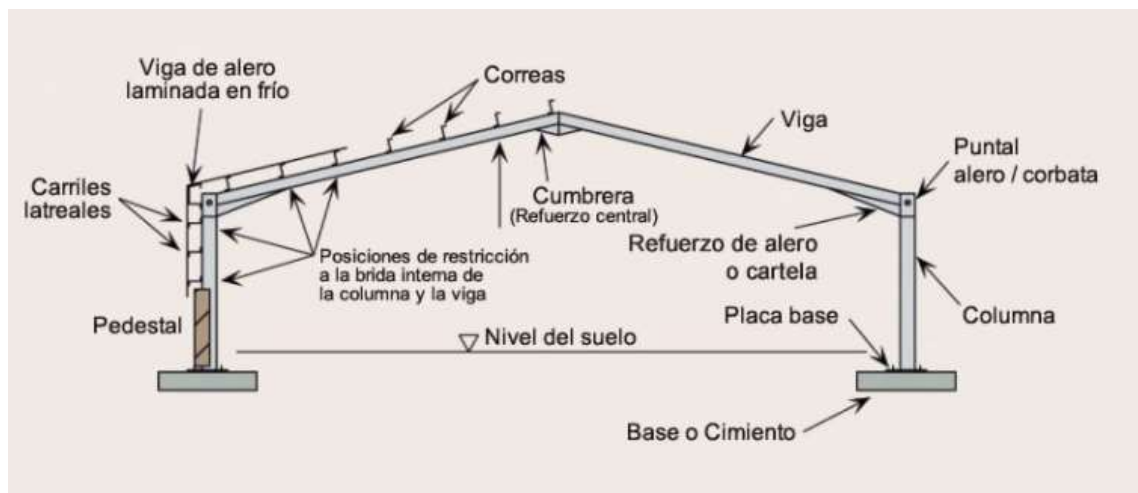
Sección transversal de un pórtico tipo galpón.
